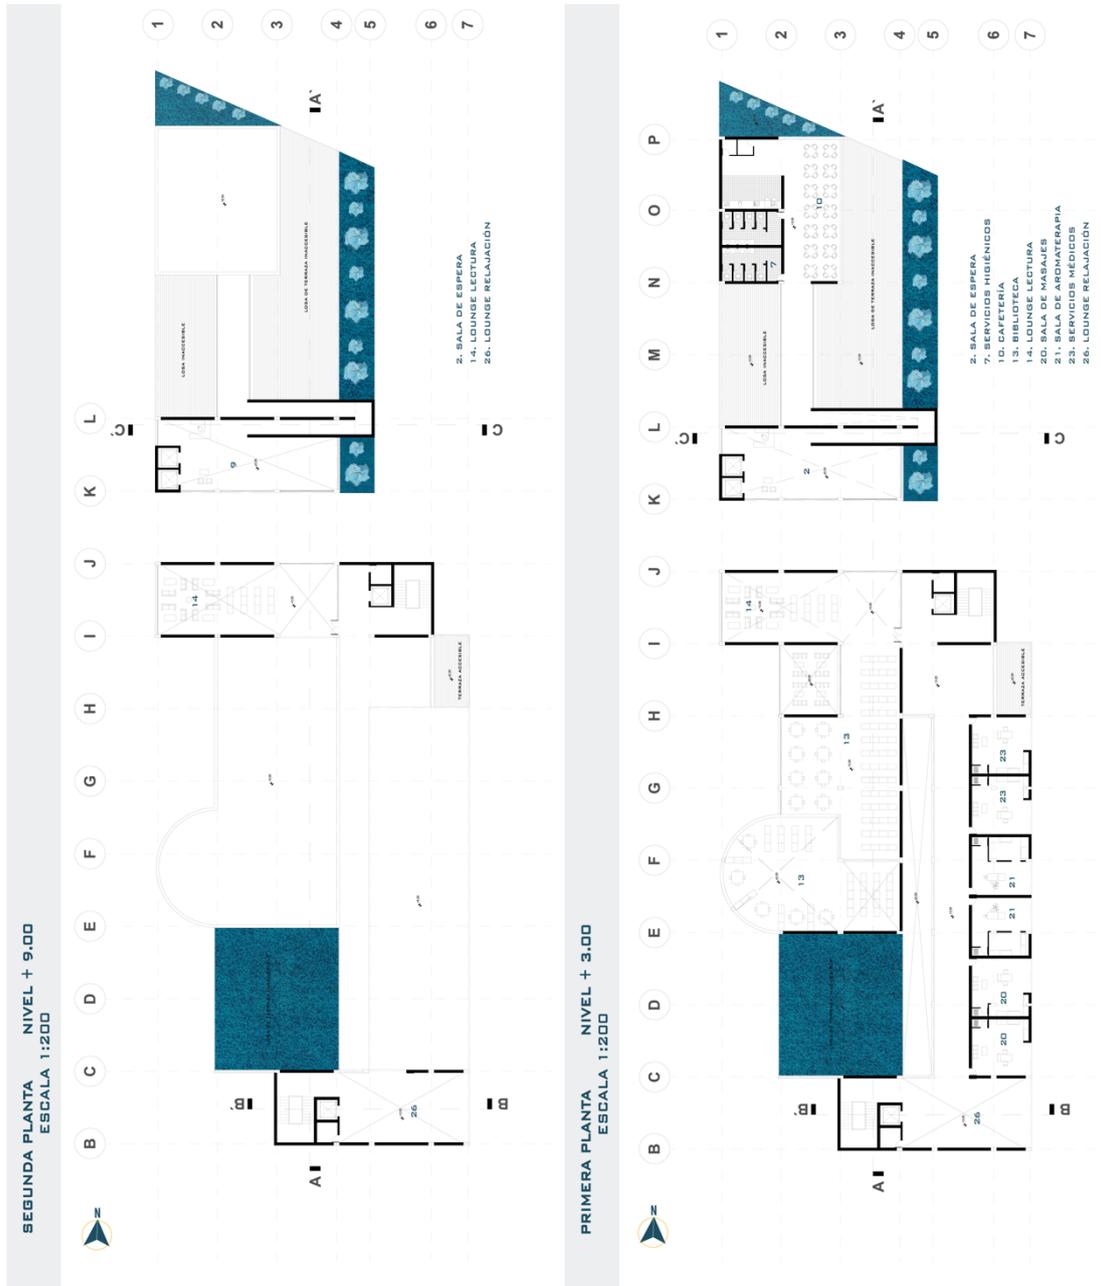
Planta Alta 1 / Planta Alta 2. (Elemento Propio)
